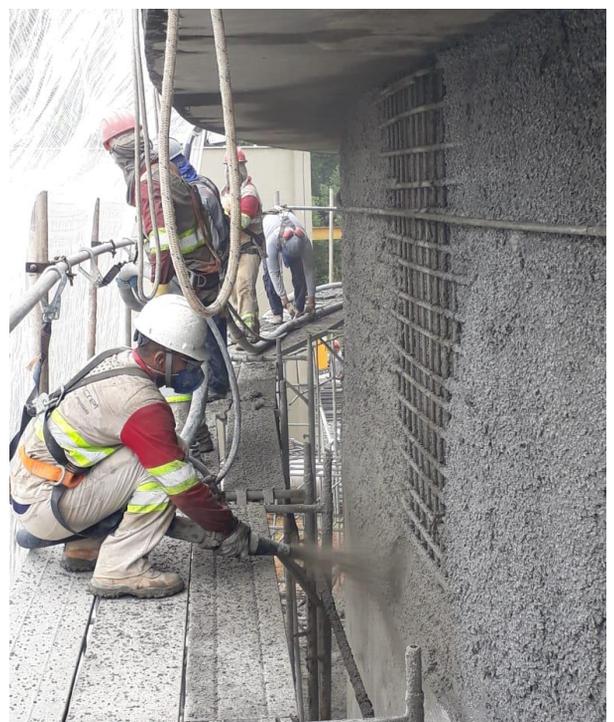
Concreto projetado com adição de Eucon Vandex AM 10
